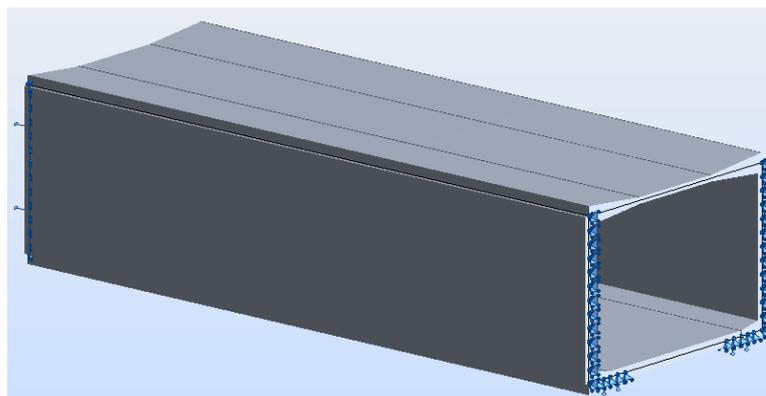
Vista tridimensional do modelo de cálculo local da viga caixão
